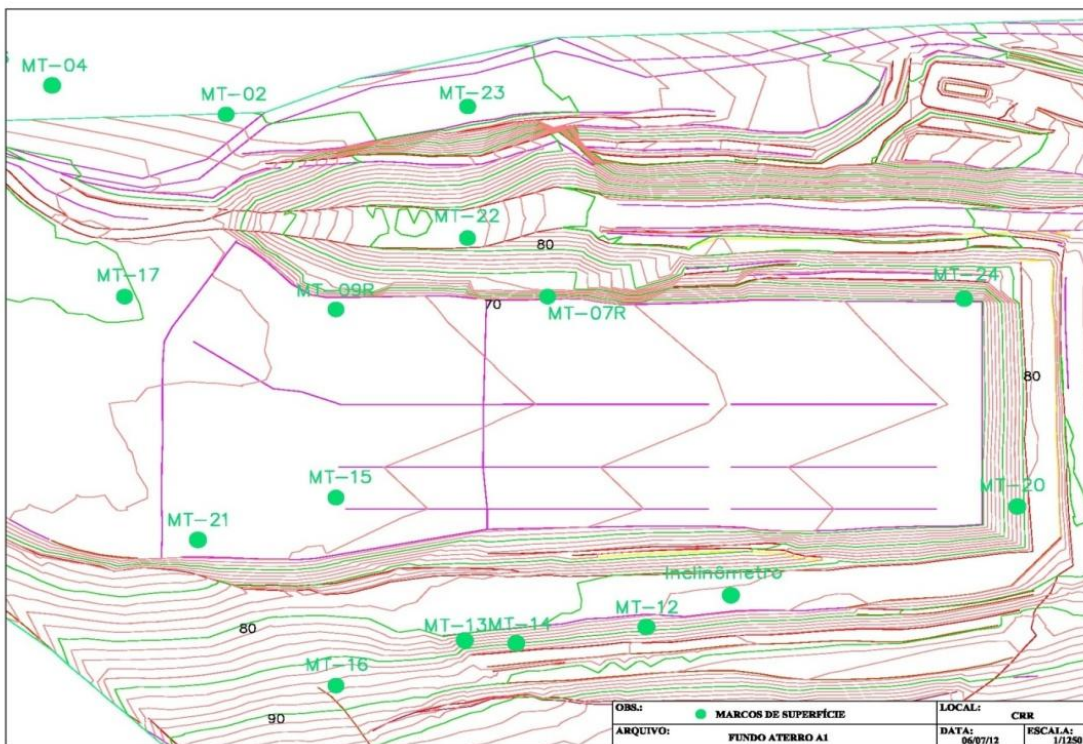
Planta da topografia de fundo da Área 1 do aterro CRR de Minas do Leão.
